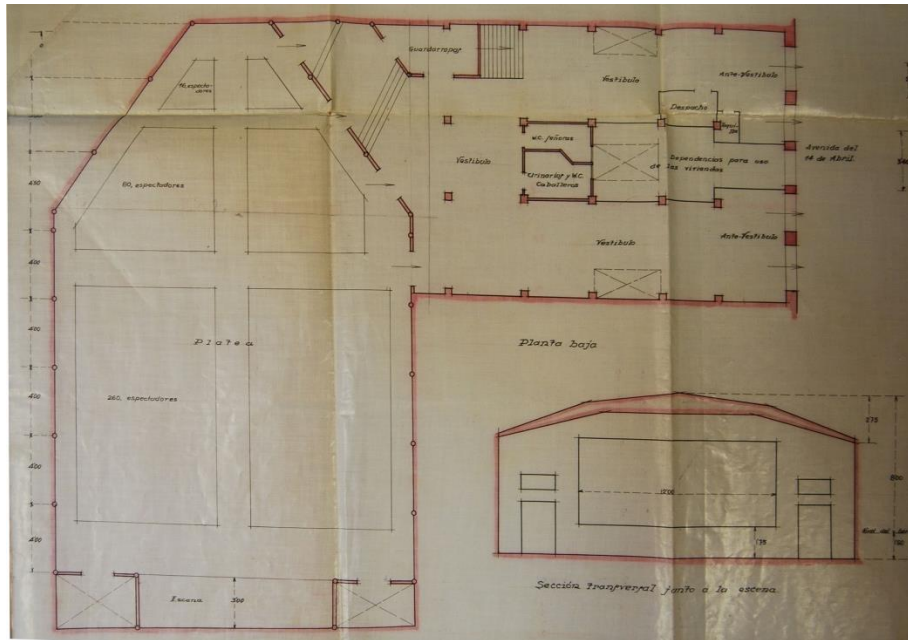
Lámina que incluye el plano de la planta baja y la sección transversal del cine Tyrus
